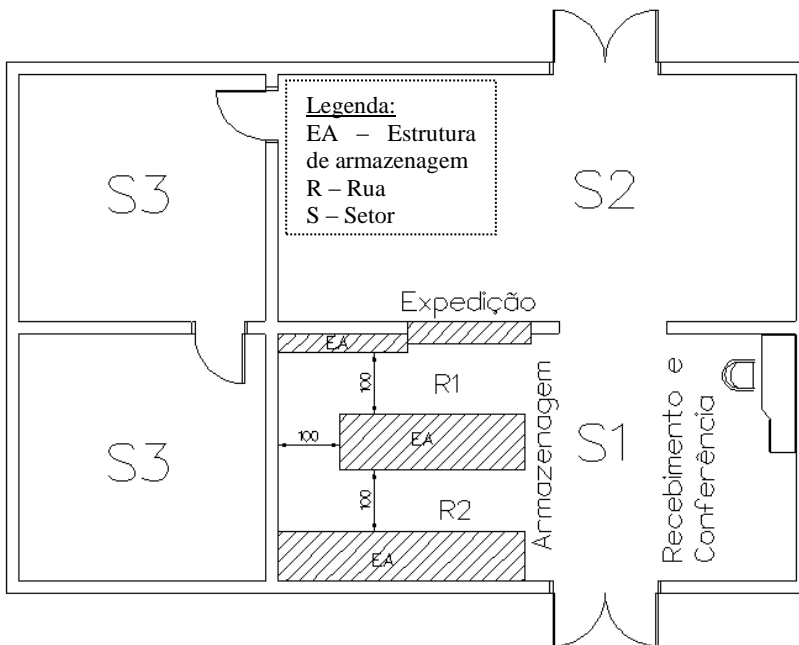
Planta Baixa do Almoxarifado Central do LMM.
